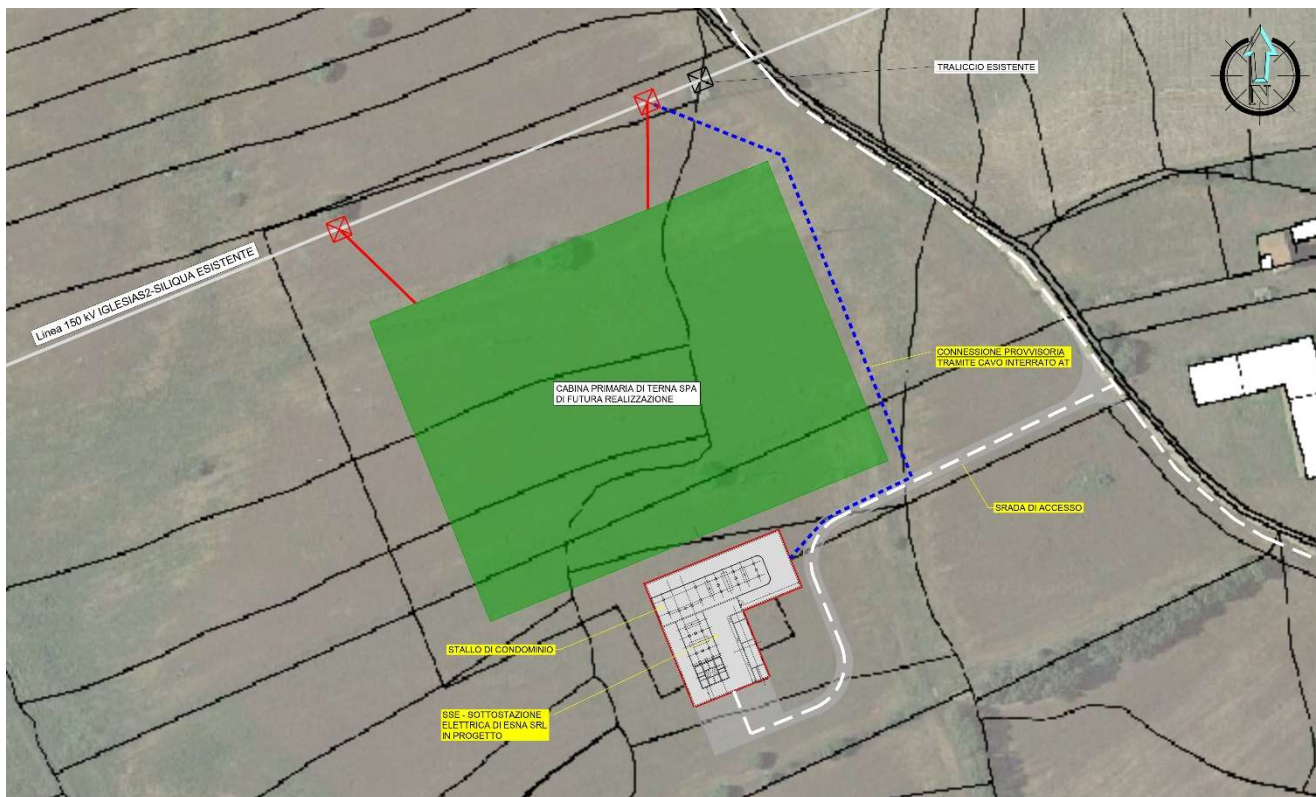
Connessione dell'impianto eolico - Progetto approvato
